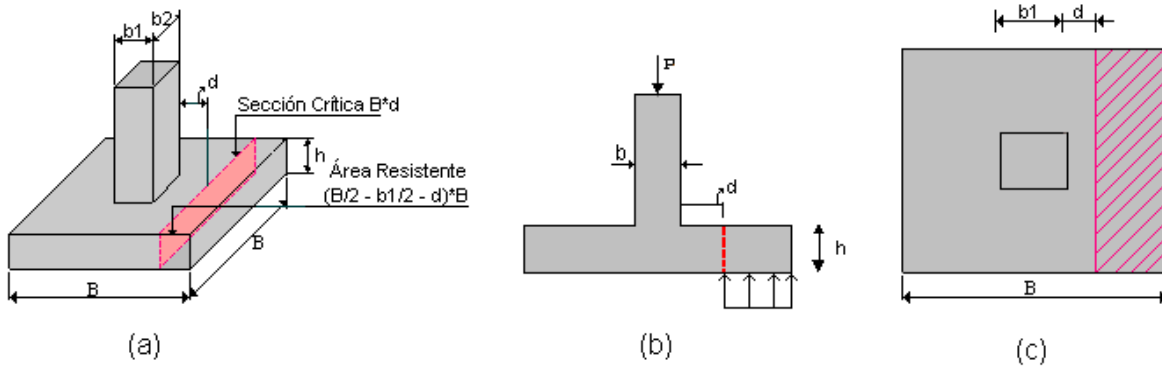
Cortante Unidireccional en Zapata que Soporta Columna, Pedestal o Muro de Concreto.
